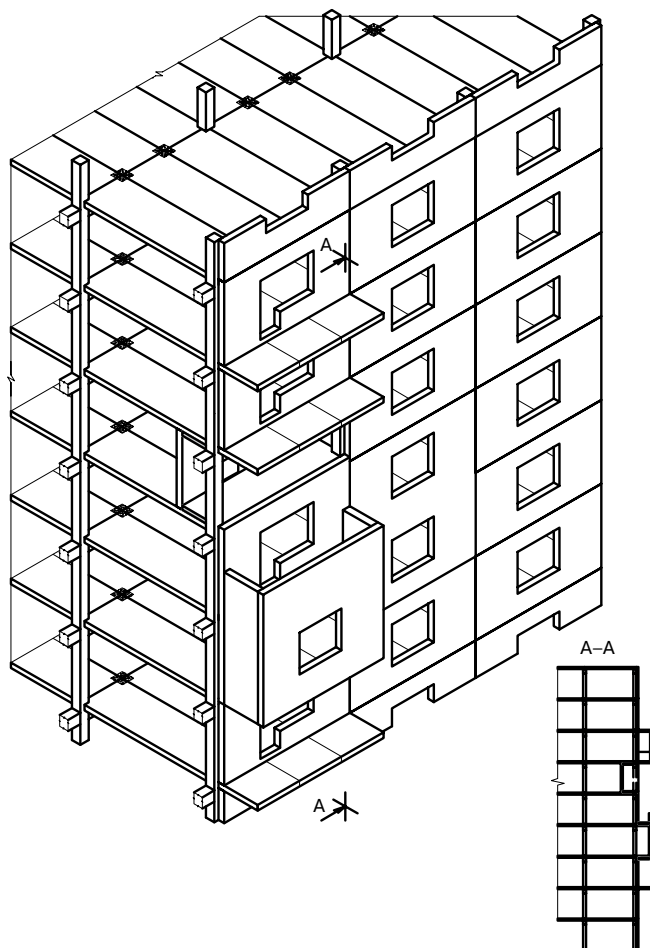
Панельно-каркасное здание с консольным выпуском многоярусных плит балочной конструкции
